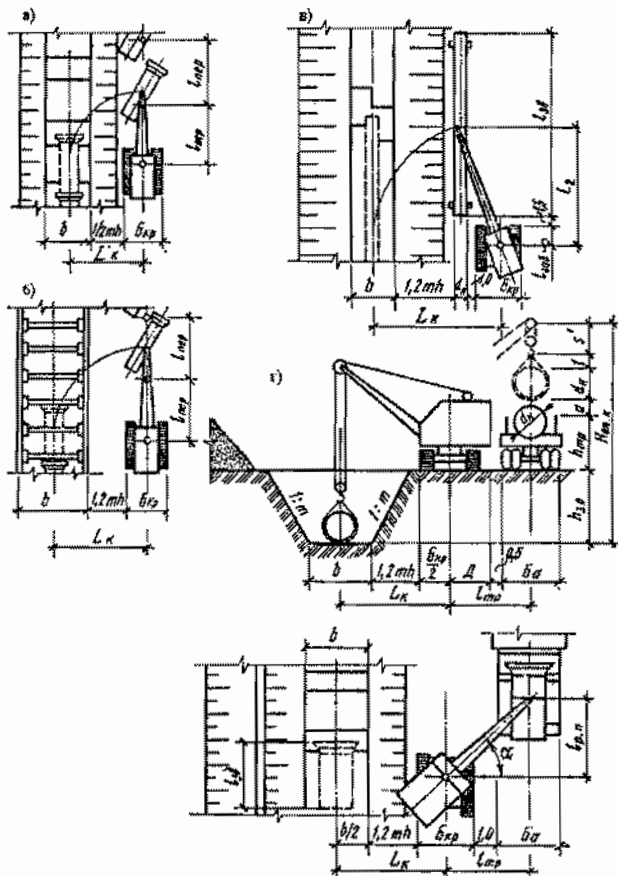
Схема определения рабочих параметров крана при прокладке труб: а - укладка одиночных труб в трапециевидную траншею; б - то же, в траншею с креплениями; в - монтаж трубных секций; г - монтаж труб с транспортных средств
